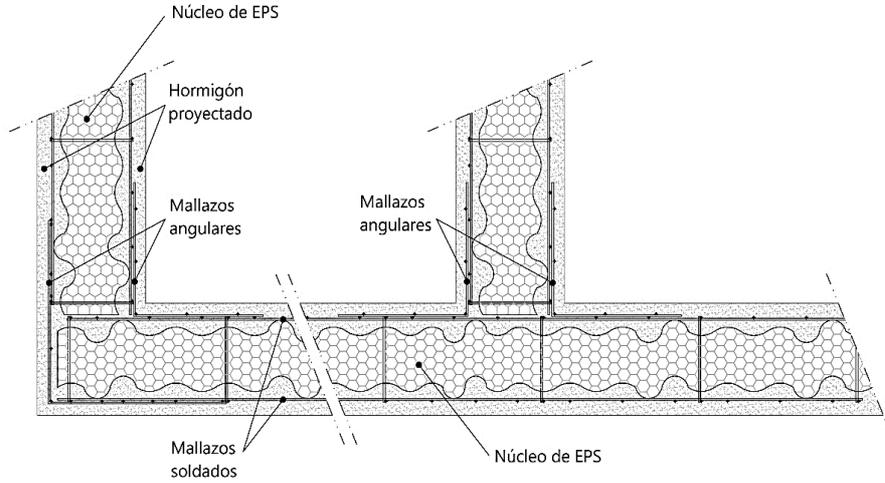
2. Uso de mallazos planos en refuerzos (sección vertical y horizontal). Ejemplo
